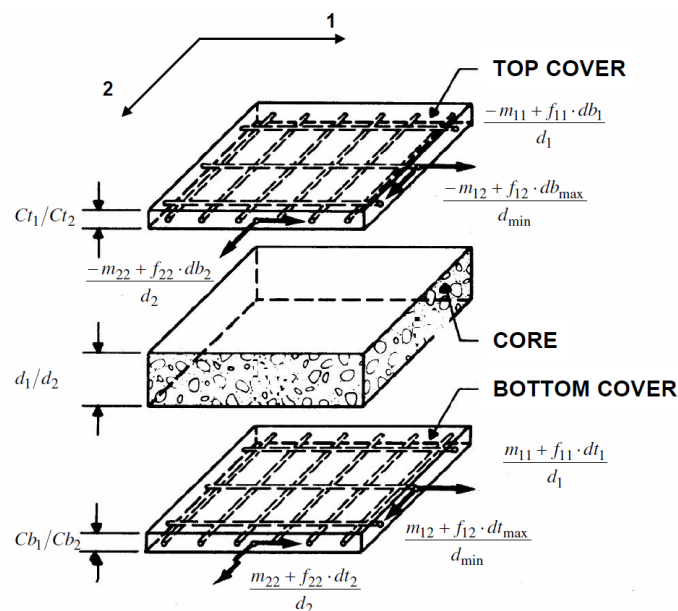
Estática de un elemento de losa: sandwich model o Modelo de Descomposición en 3 capas. Concrete Shell Reinforcement Design [10]
